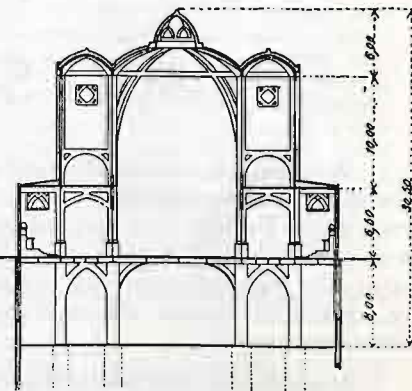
Plan kościoła Św. Jana w Paryżu.
